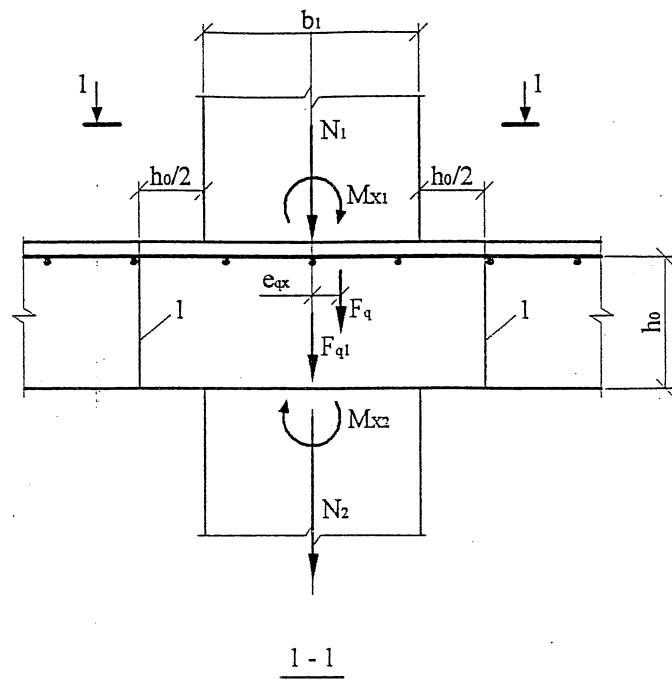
Схема для расчета железобетонных плит без поперечной арматуры на продавливание при действии сосредоточенной нормальной силы и сосредоточенных моментов в направлении X и Y
